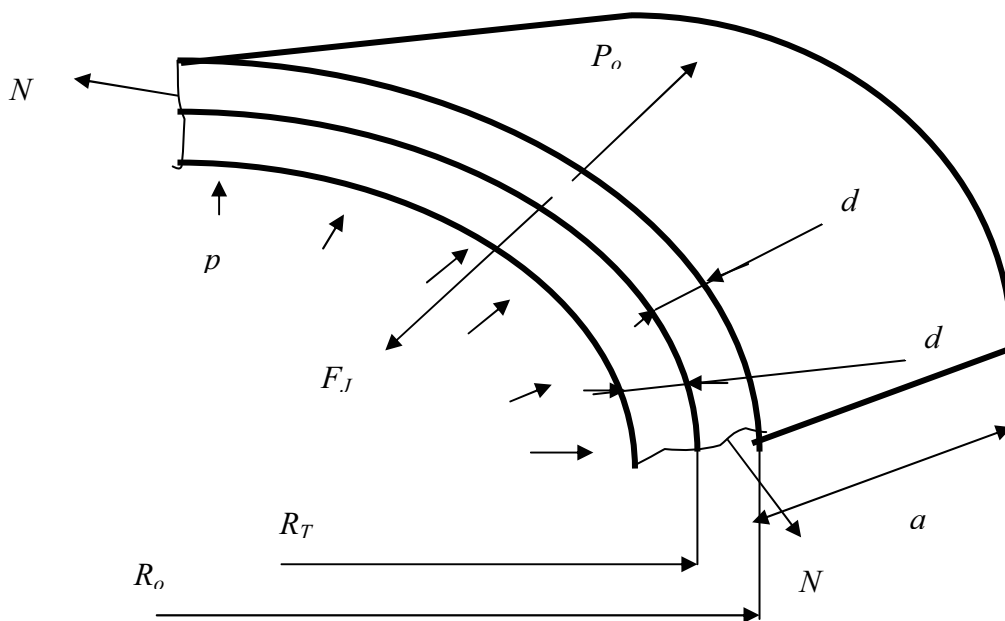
Элемент сечения трубопровода, усиленный наружным бандажом
